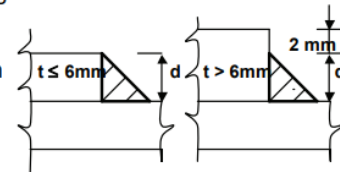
Recorte del libro "Estructuras metálicas - Proyecto por estados límites"
